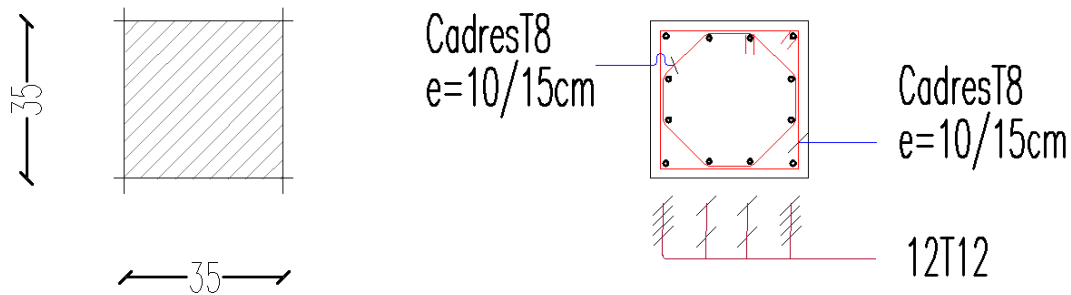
Schéma de ferrailage des poteaux 35x35
